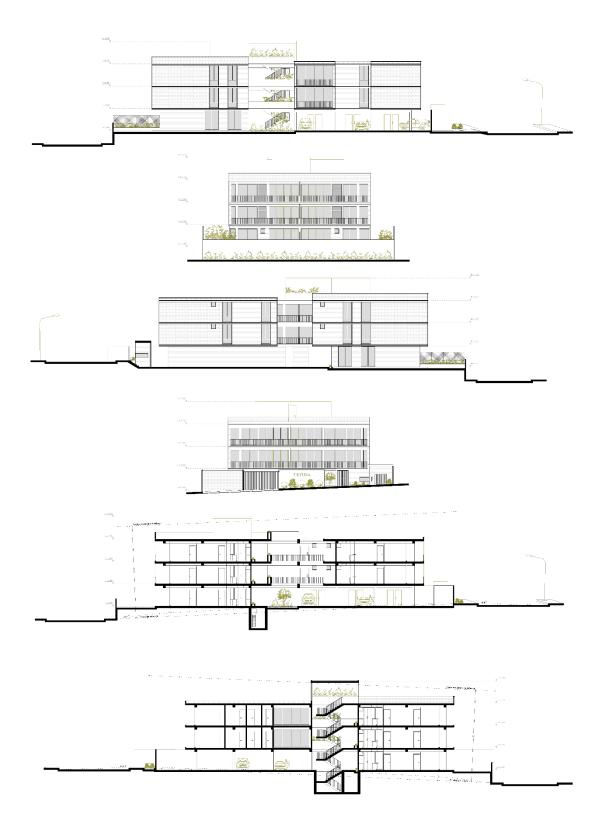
Secciones y alzados. Adaptado de: R3C Constructores. Fuete: Elaboración propia.
